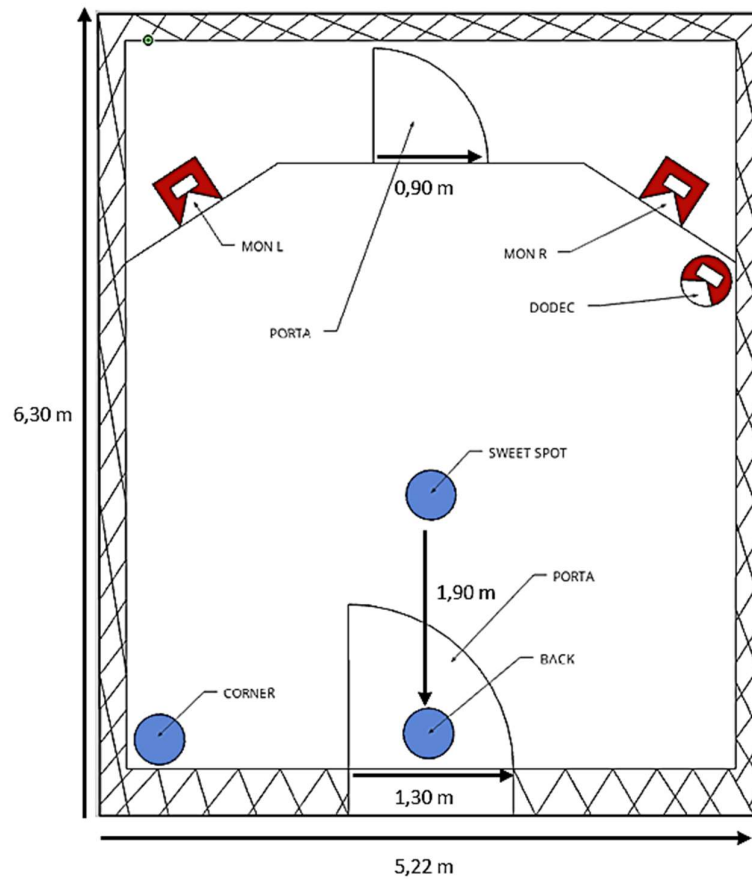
Visão em planta da sala "ARDA – Mastering Studio"
